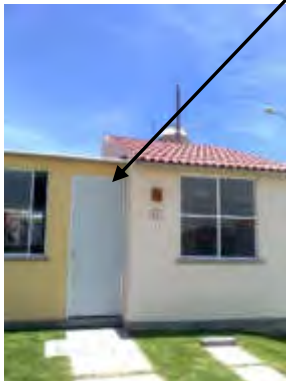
detalles de fisuras y juntas fuente autor
